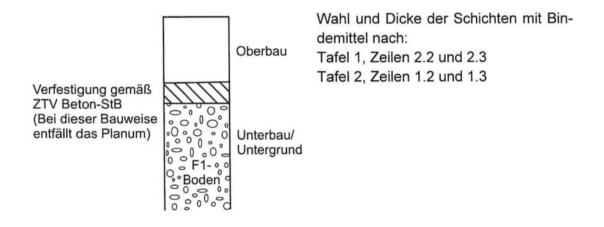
Bauweisen auf F1-Boden mit Verfestigung gemäß ZTV Beton-StB
